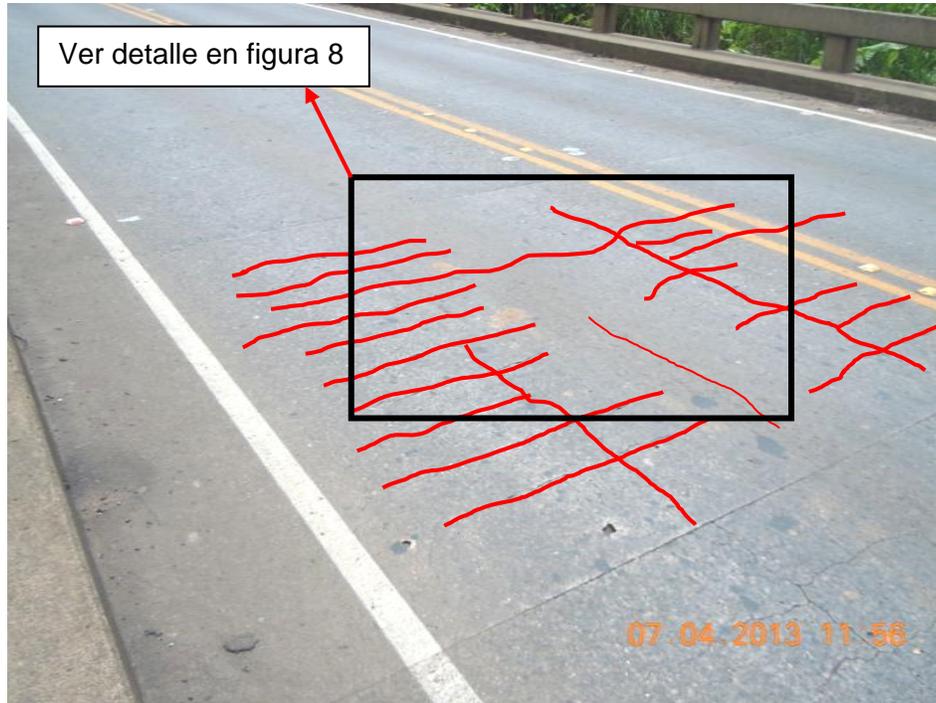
Grietas transversales y longitudinales en la superficie superior de la losa (típico).
